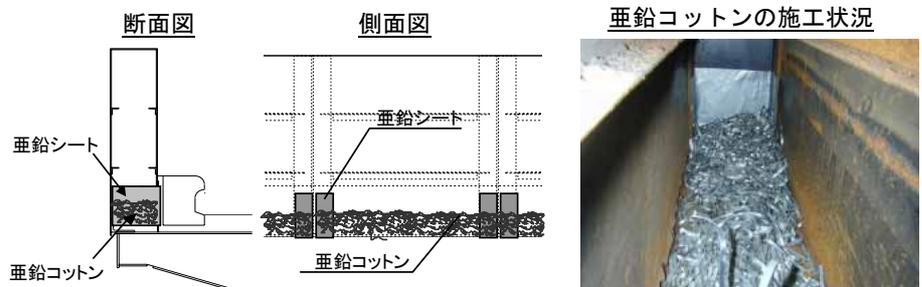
電気防食工法（亜鉛コットン）の施工図と状況
